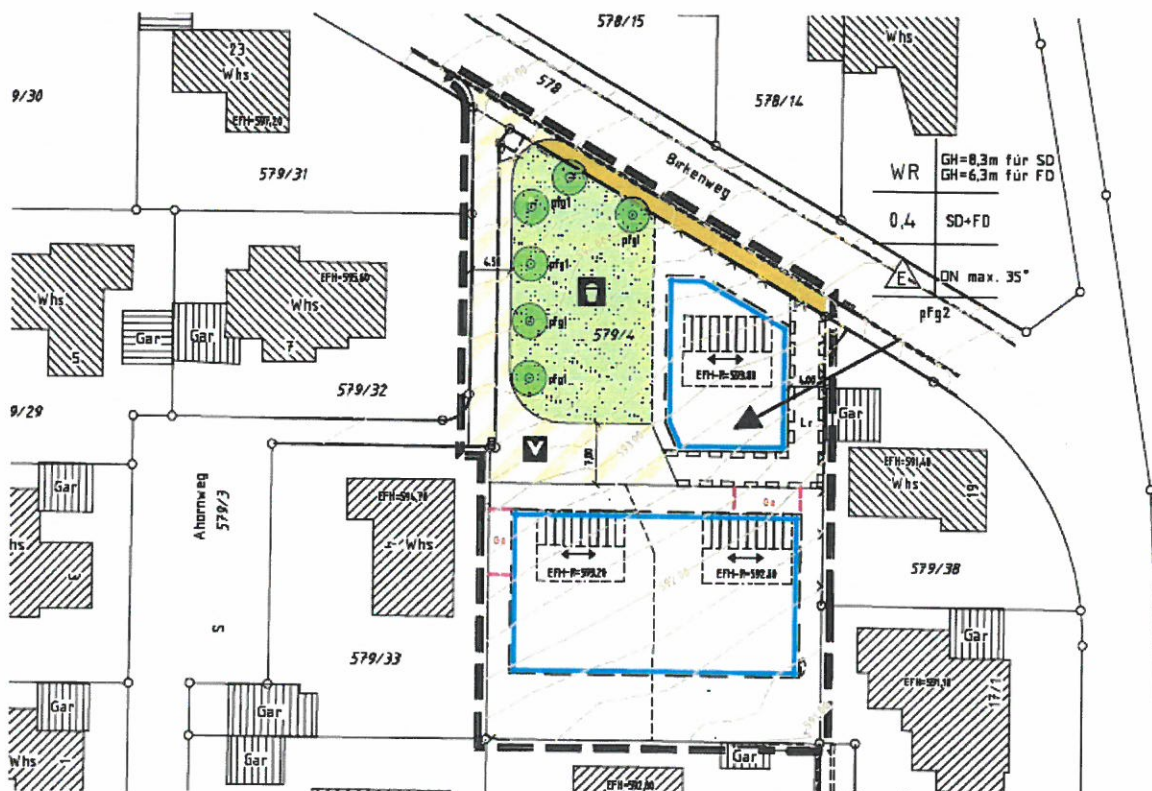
Auszug aus dem Bebauungsplan „Birkebene IV – 2. Änderung Flst. 579/4“ (Quelle: Stadt Blaustein, 11.04.2022)
